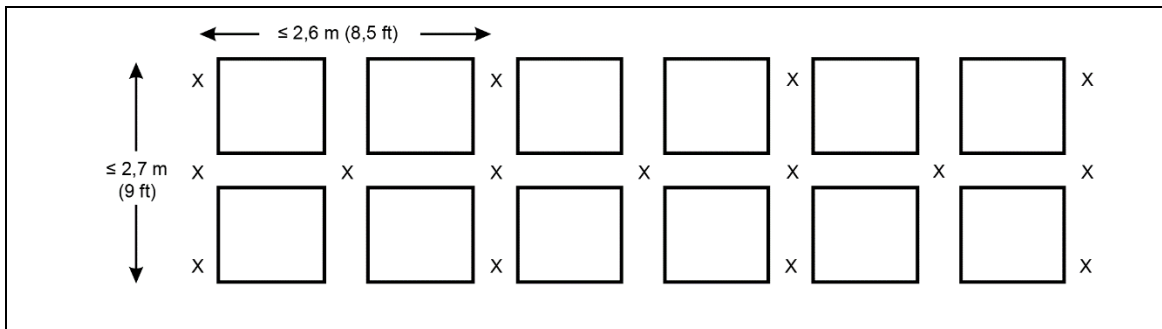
Vista en planta de una configuración alternativa de rociadores intermedios para estanterías dobles con una anchura máxima de 2,7 m (9 ft)
